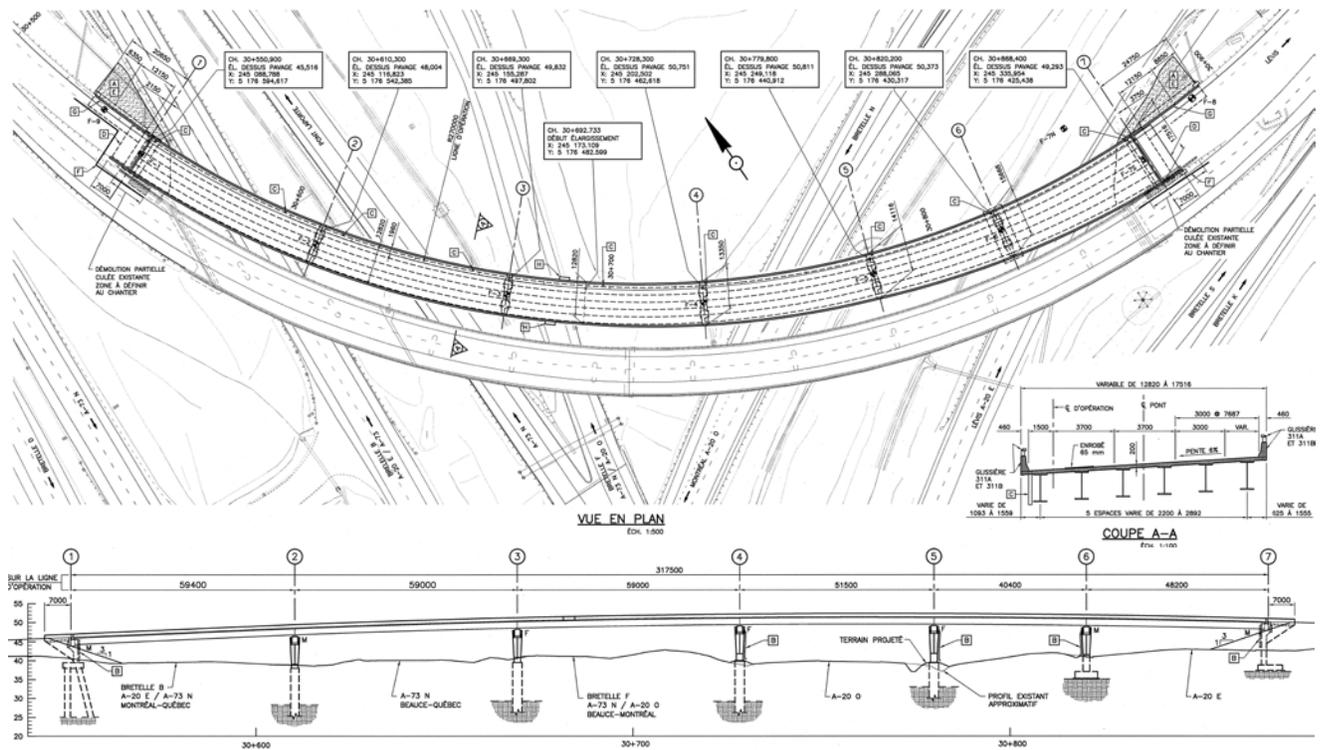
Vue en plan, coupe transversale et élévation du pont construit à Québec
